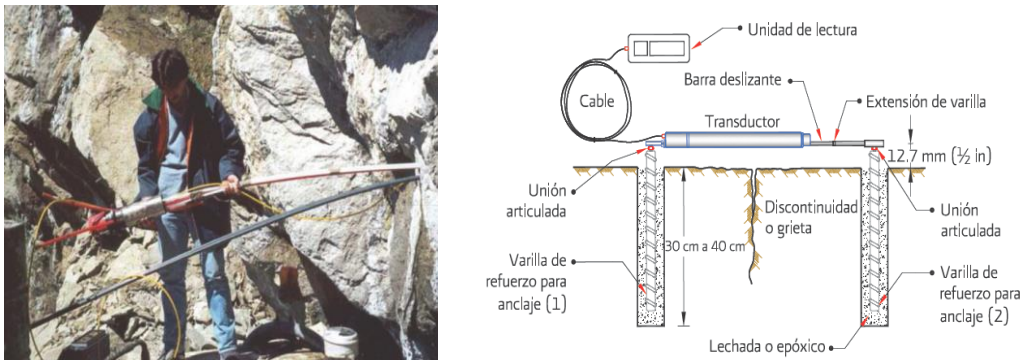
Extensómetro interno de barras y extensómetro externo de juntas y grietas (eléctrico). Fuente: Instrumentación y Monitoreo del comportamiento de Obras Hidráulicas
